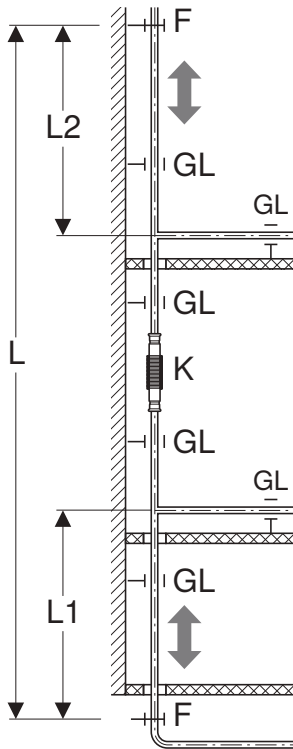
Compensación de la dilatación mediante compensadores axiales con punto fijo en la planta inferior y en una planta intermedia
